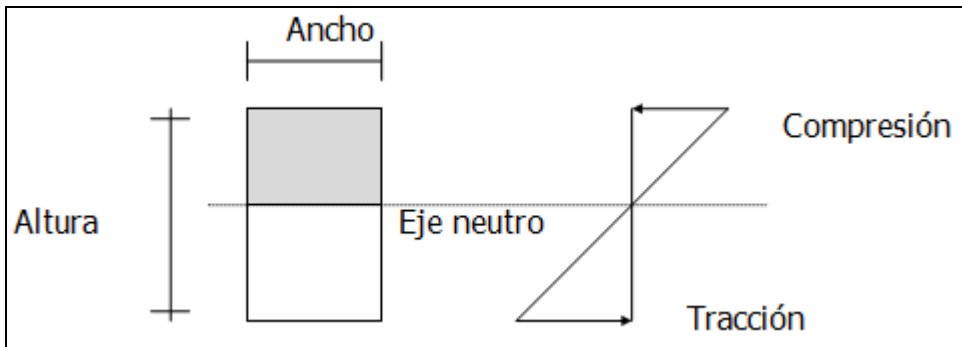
Diagrama de esfuerzos para una sección de concreto armado.
